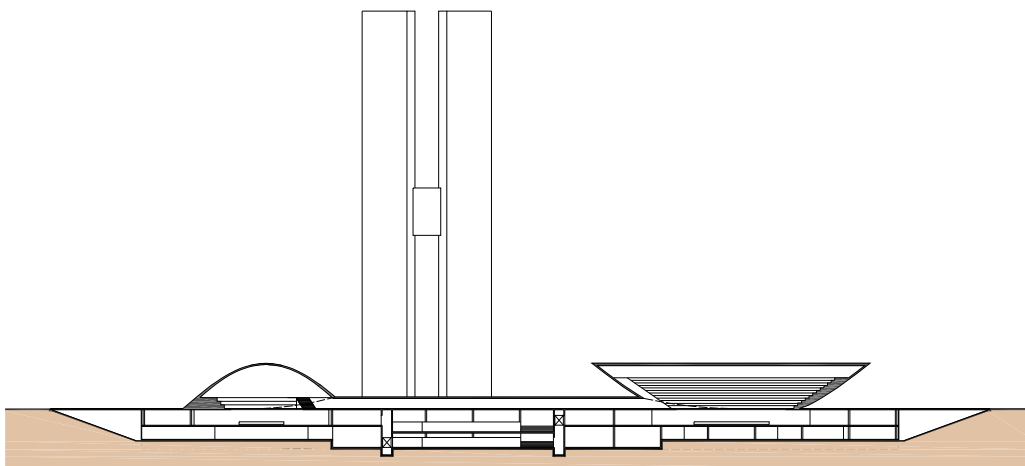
Anteprojetto 01 – Corte Longitudinal. 1957.
